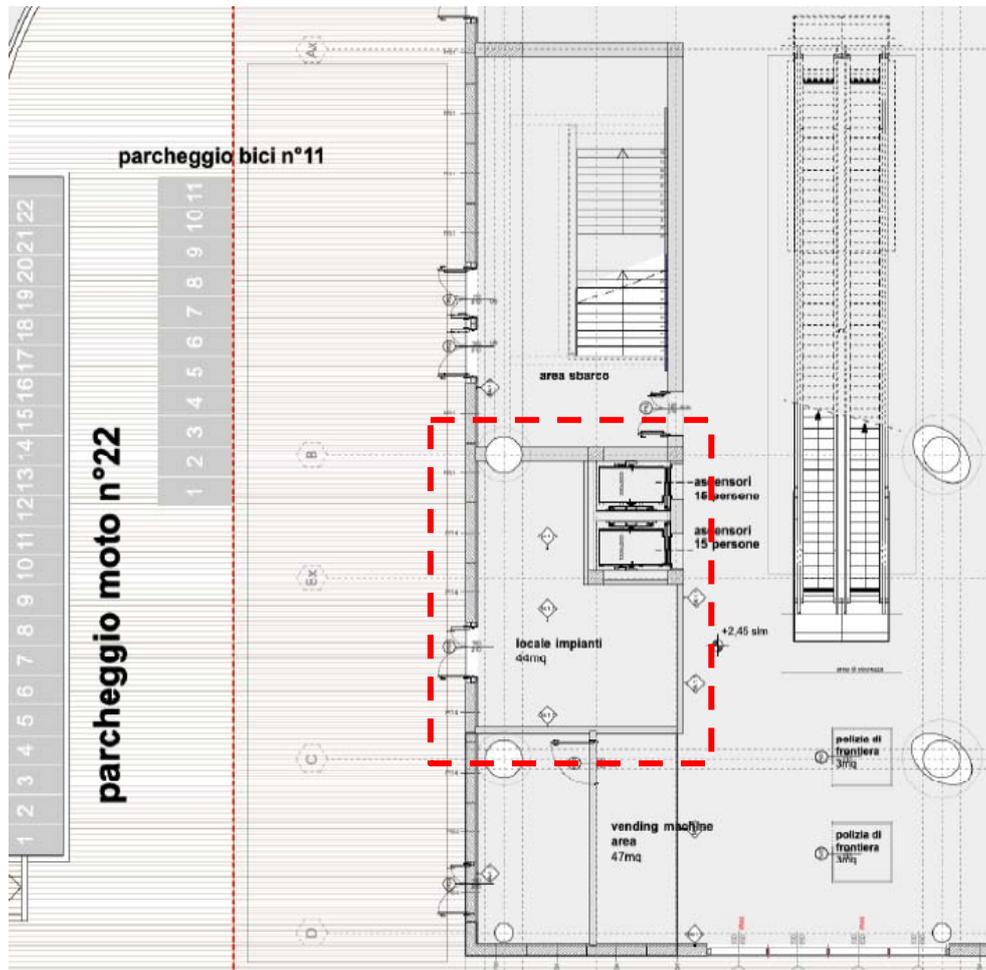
Piano terra, lato nord: locale impianti (dettaglio)
